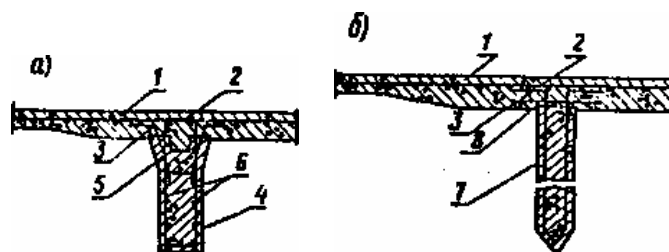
Схема сопряжения анкеров с непрерывно армированным покрытием:
